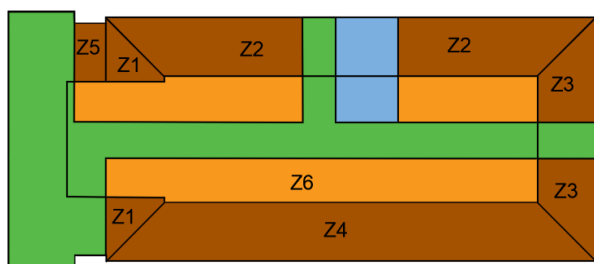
Zonas térmicas repetidas no quarto e no quinto pavimento. Em verde: circulação; em azul: instalações sanitárias; em laranja: zona interna; em marrom: zonas periféricas (Fonte: Elaborado pelos autores, 2022).
